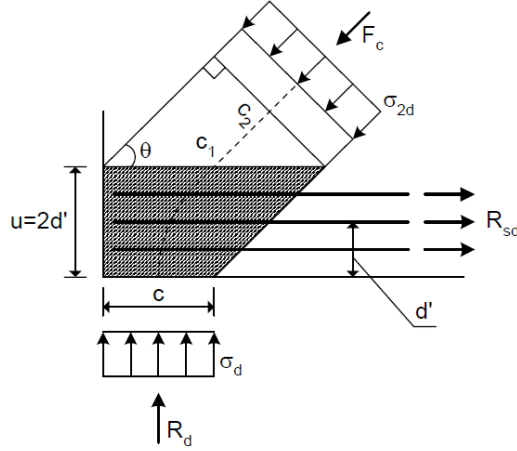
Modelo biela e tirante para viga parede biapoiada
